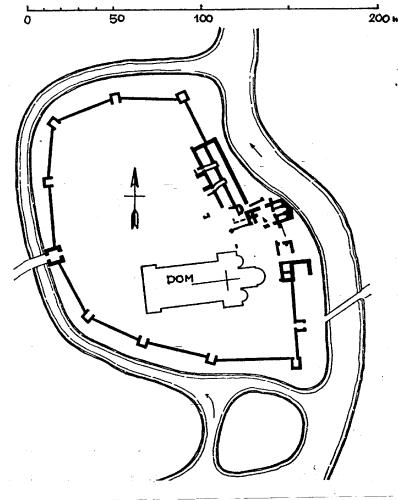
Lageplan der Burg Dankwaderode, Braunschweig
